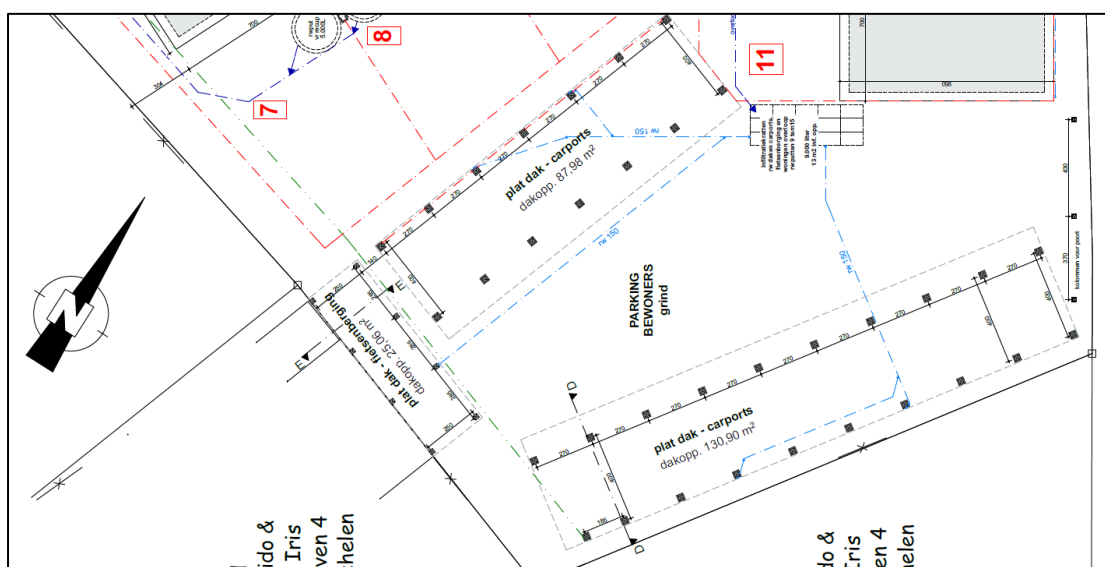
detail van de carportfundering © architect N. Cornelissen
